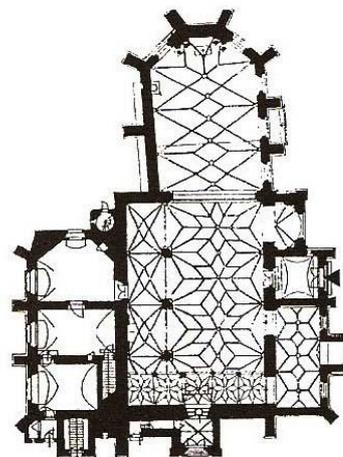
Rožňava, Marienkirche, Grundriss, um 1490-
